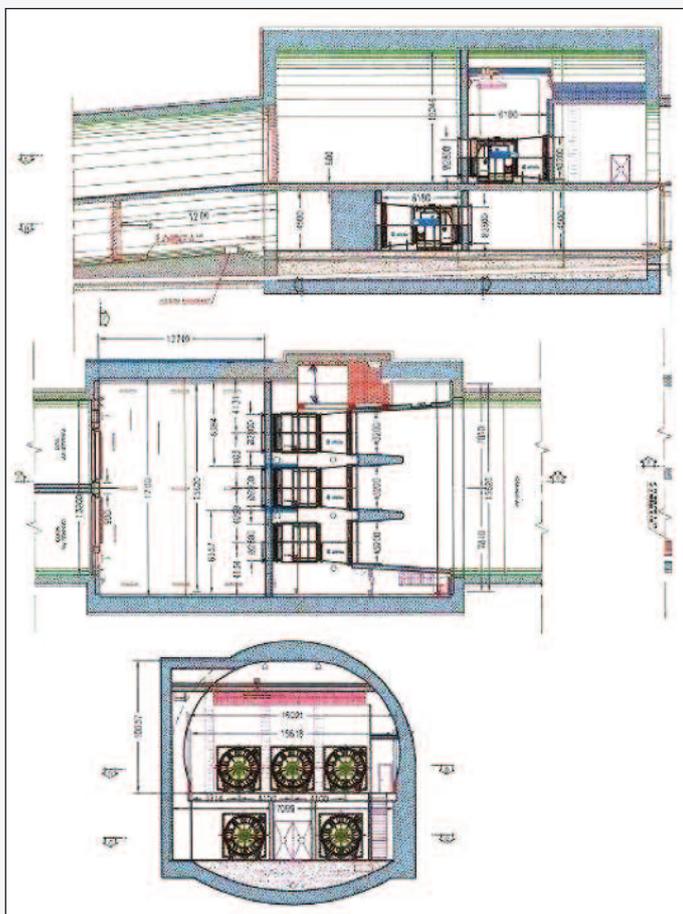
Il layout progettuale del sistema di ventilazione principale
